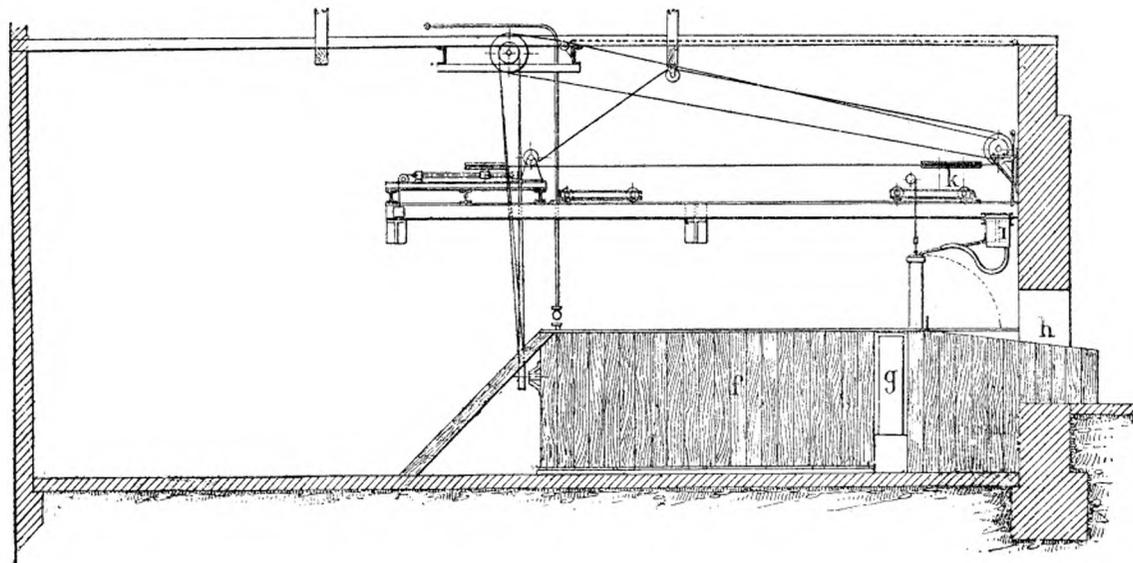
Frigorifère Fixary de Créfeld.* — Coupe EF, pl. 17-18 .
